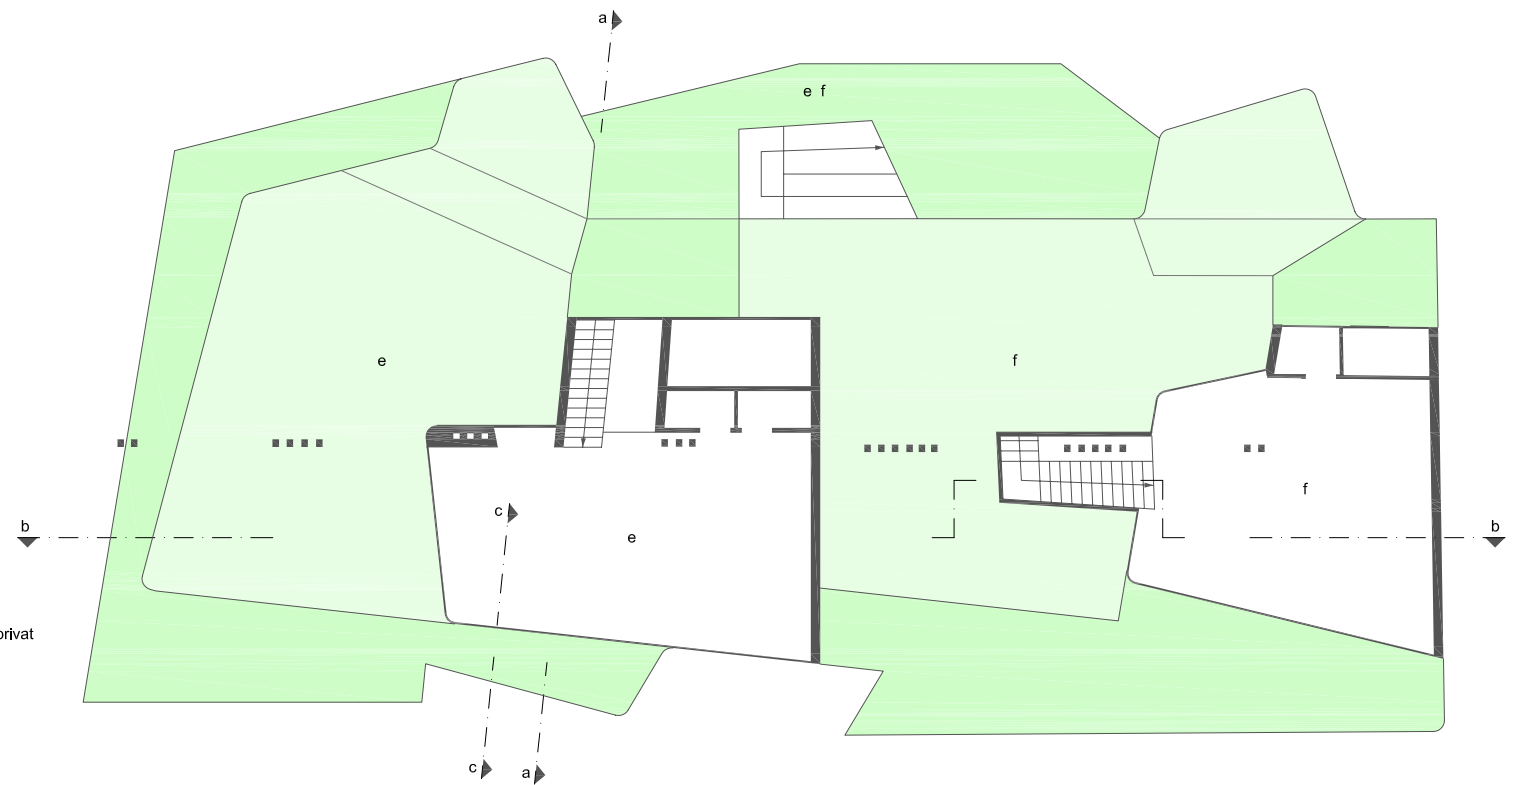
Grundriss 4. Obergeschoß
